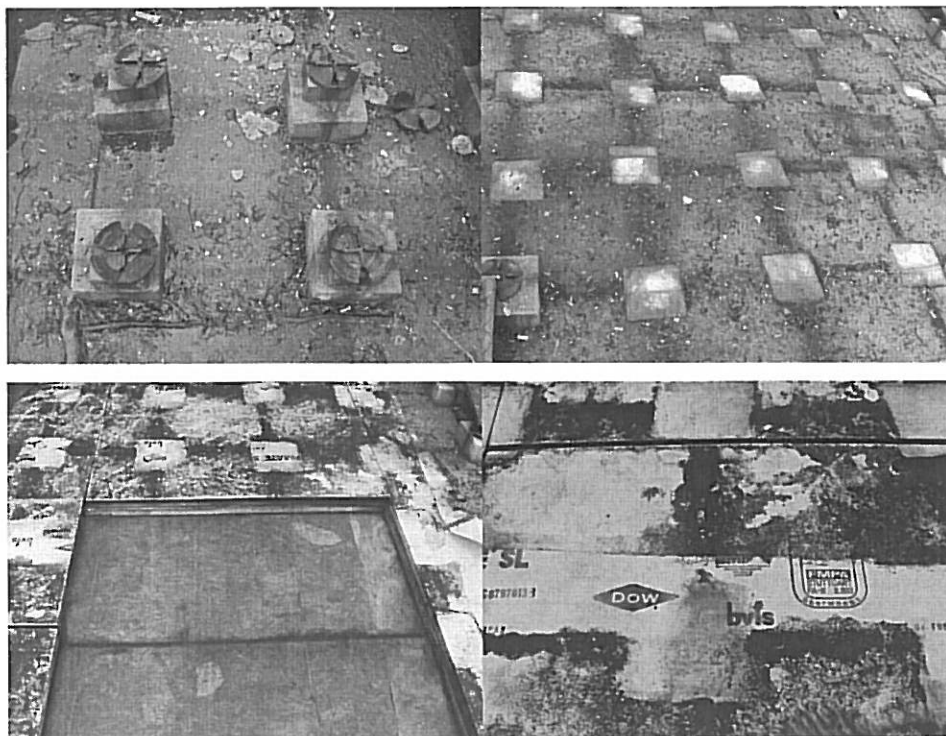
Demontovaný plášť OD Tesco včetně detailu stavu terasy
